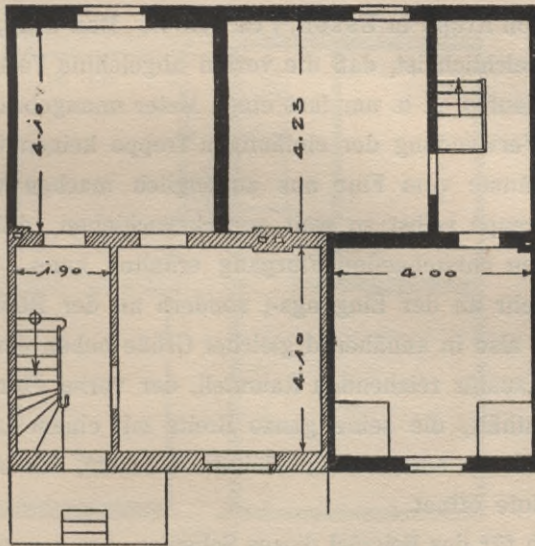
Typ 3b: Vier Wohnräume, so angeordnet, daß Erd- und Obergeschoß gleichartig geteilte Grundrisse haben (Reihenhaus). Beispiel nach einem Hause der Stadt Köln für das Gaswerk Köln-Ehrenfeld. (Vgl. Festschrift a. a. O.)
